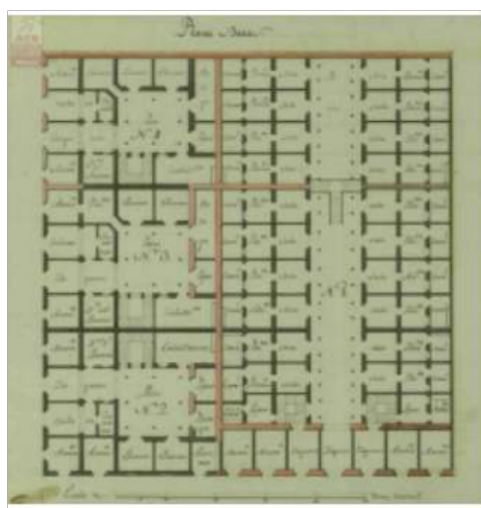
Planta baja de las Casas del templo de San Pedro y San Pablo. // Fuente: (Archivo General de la Nación, s.f.)
